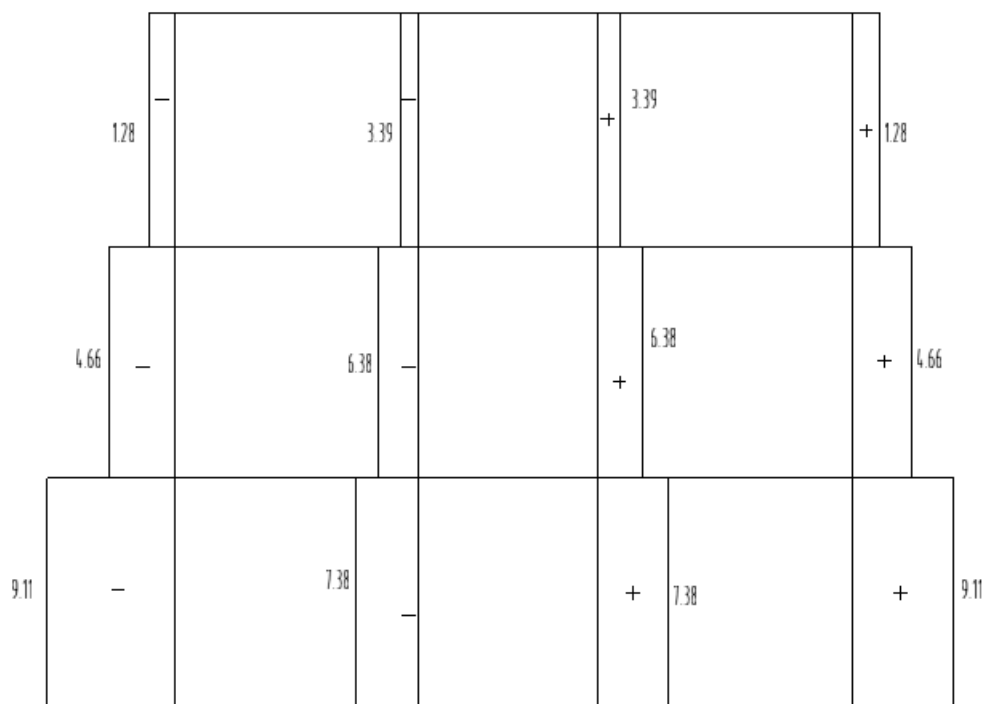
Осевая сила на конце колонны при ветровой нагрузке (кН)
